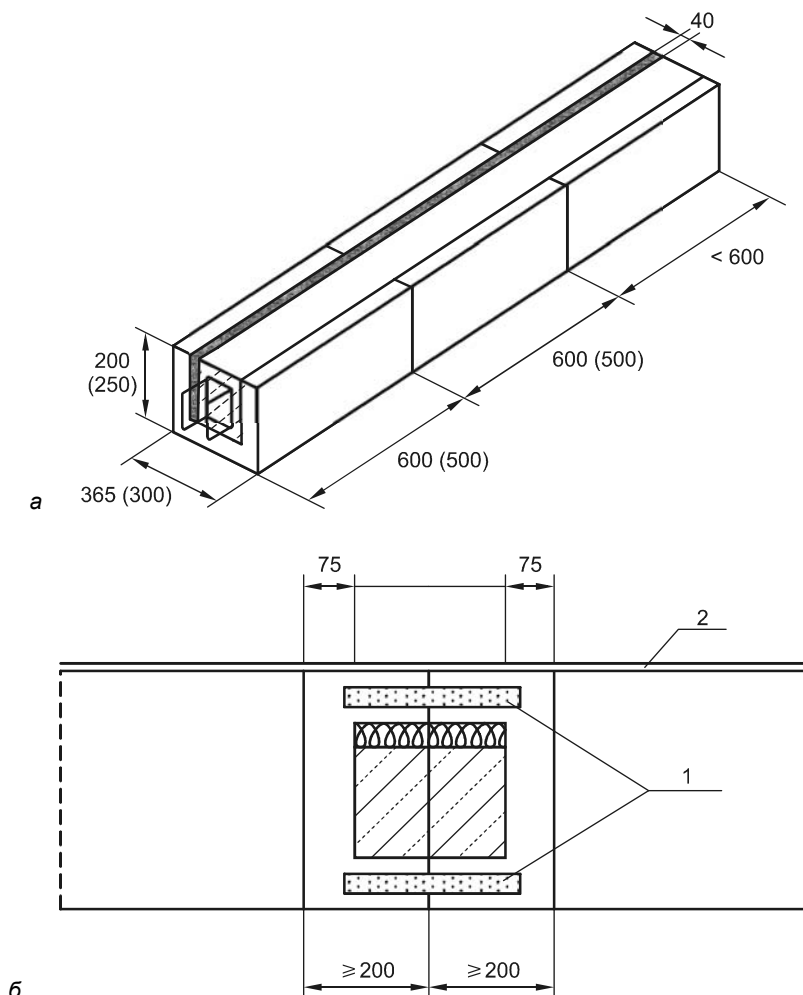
Железобетонные перемычки (а) и простенки (б), изготавливаемые из монолитного железобетона в опалубке из корытообразных пенобетонных элементов:
